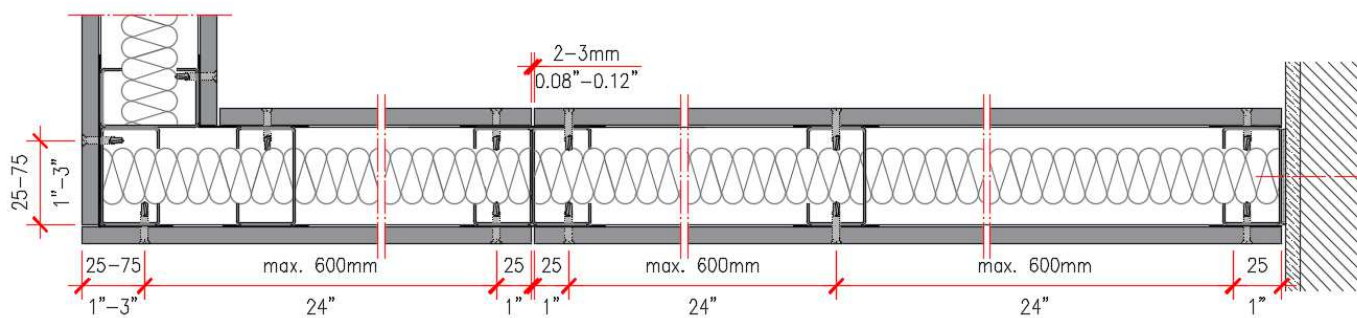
Secção horizontal da parede, estrutura de aço galvanizado
